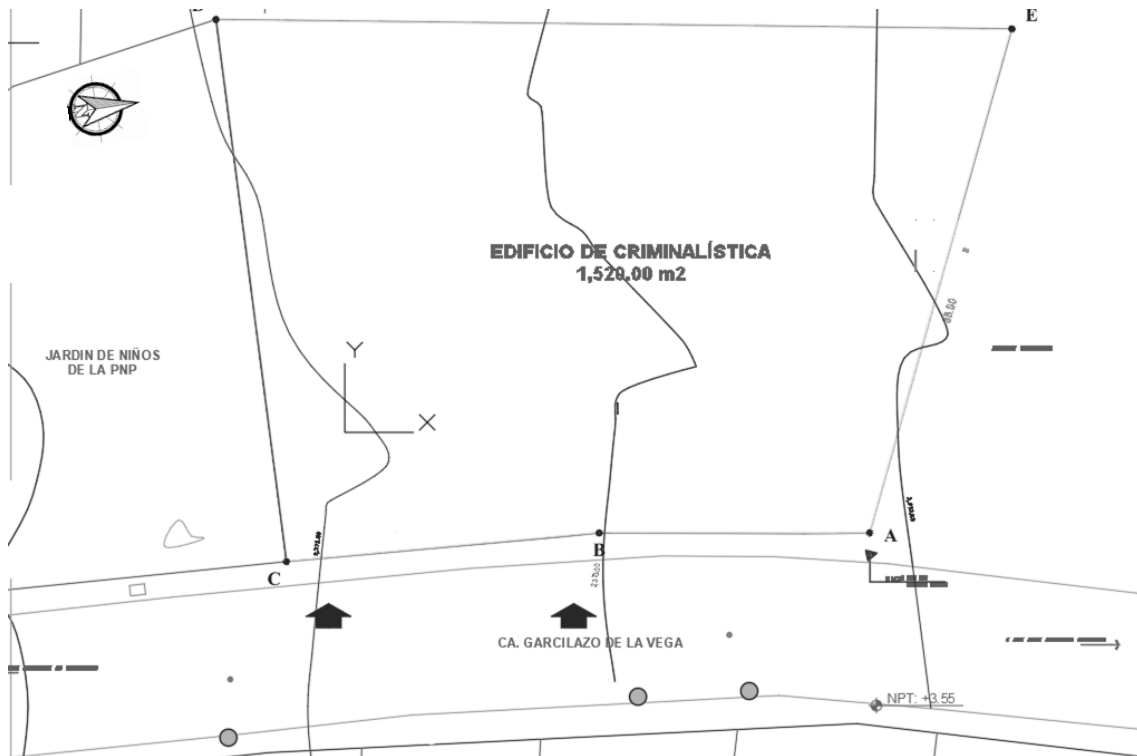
Plano de dimensionamiento del terreno seleccionado. Elaboración propia.
